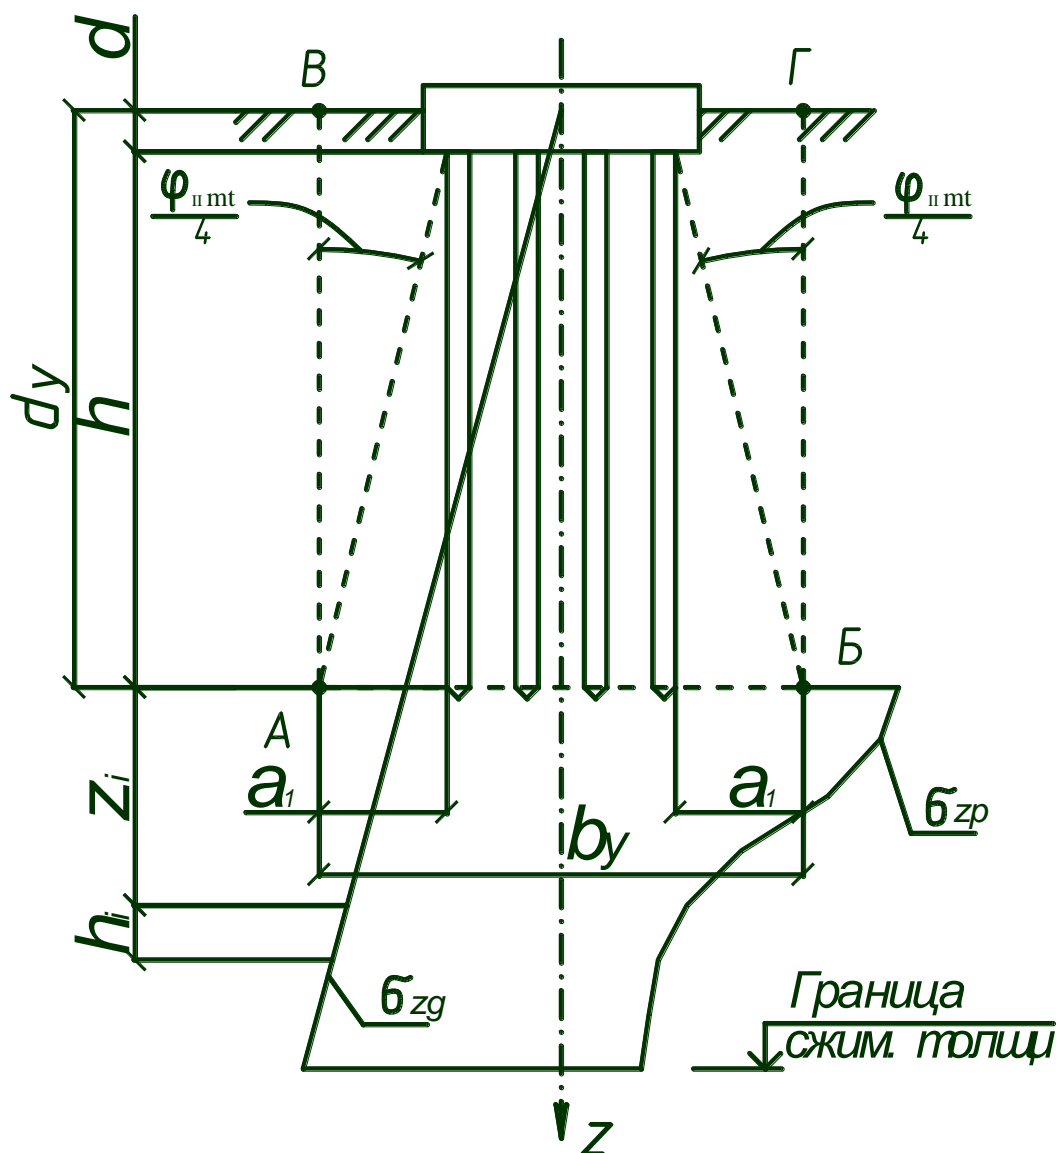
Определение границ условного фундамента при расчете осадок свайных фундаментов
